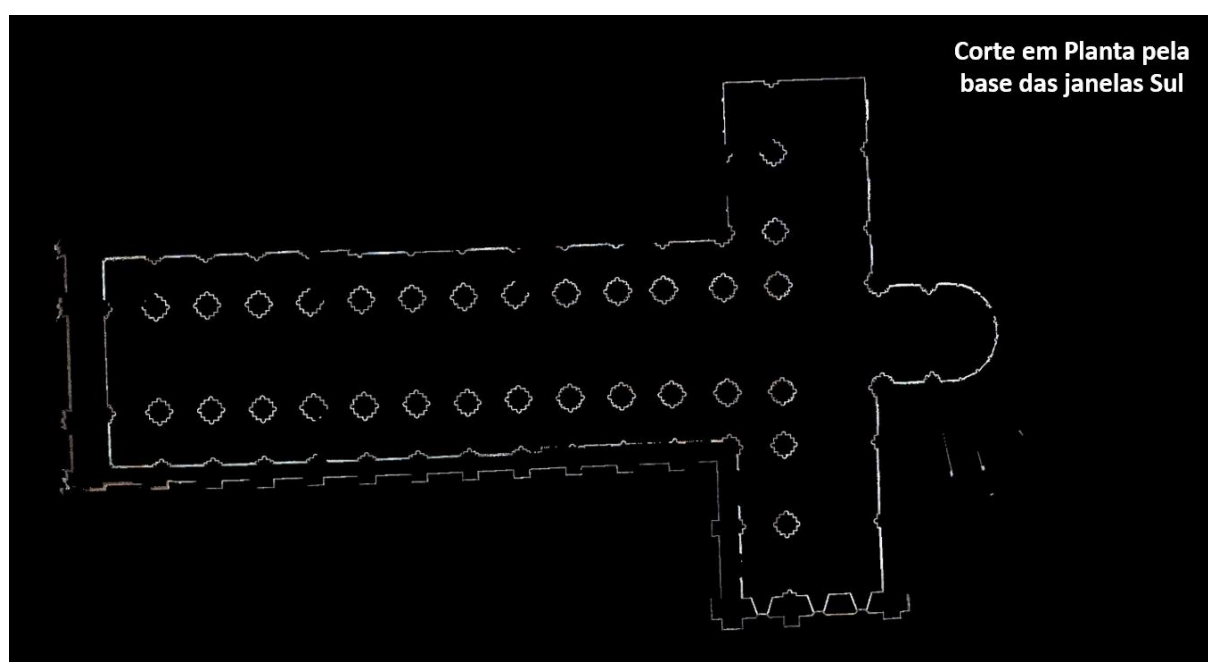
Corte em planta pela base das janelas Sul da Igreja do Mosteiro de Alcobaça.
